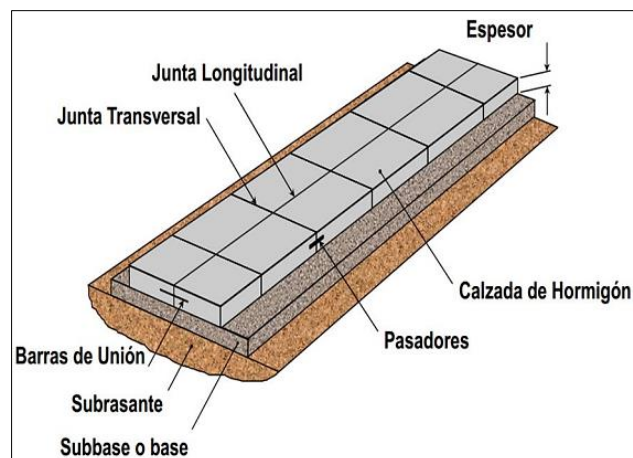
Estructura del pavimento rígido. Fuente:(Mora, 2015)
